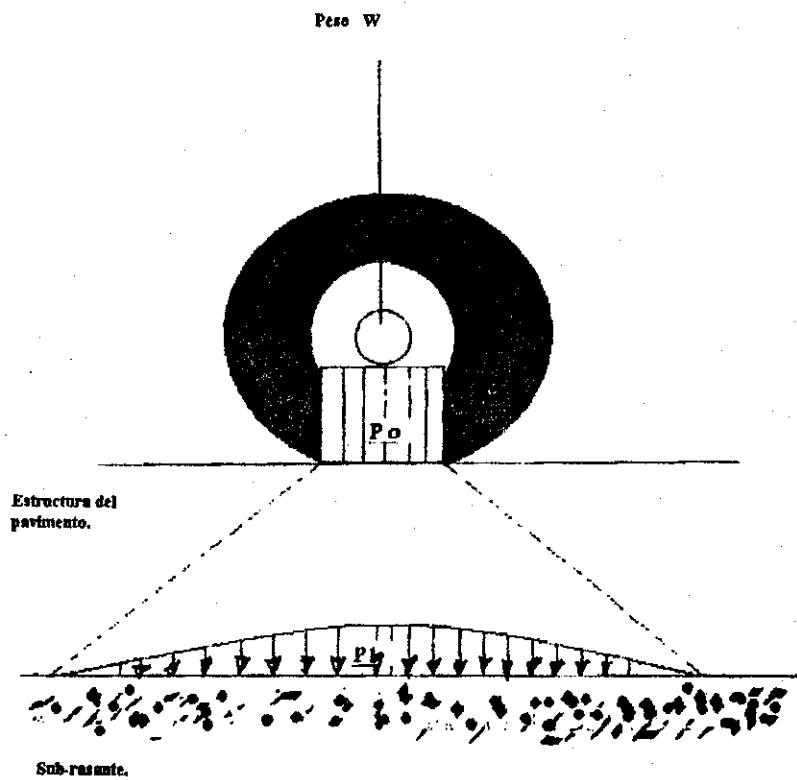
| Distribución de las cargas a través de la estructura del pavimento.
